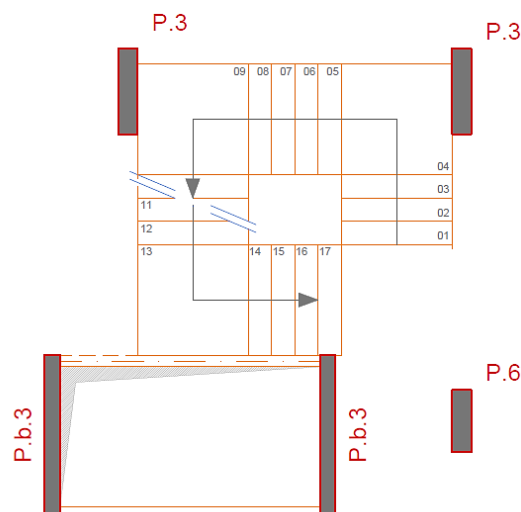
Planta da escada do lote 6.6, piso 0 ao 8.
